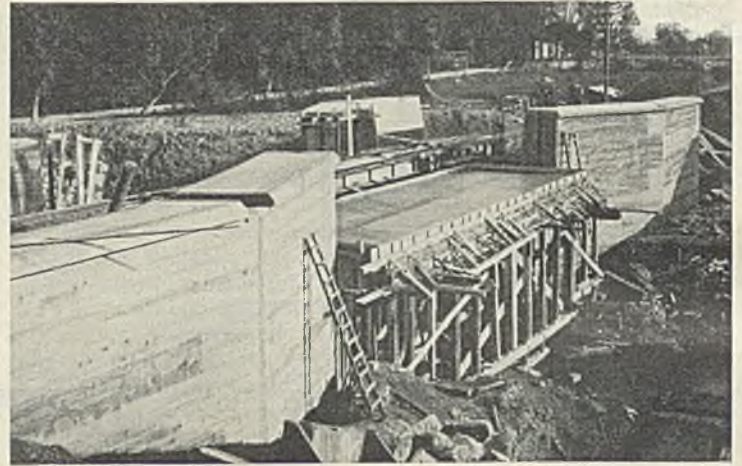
Seitlich betonierte Fahrbahnplatte.
